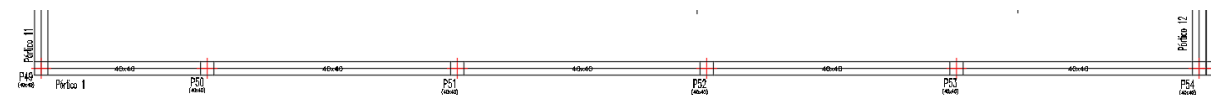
Pormenor do Pórtico 1 (Pilar P50 a P54)
